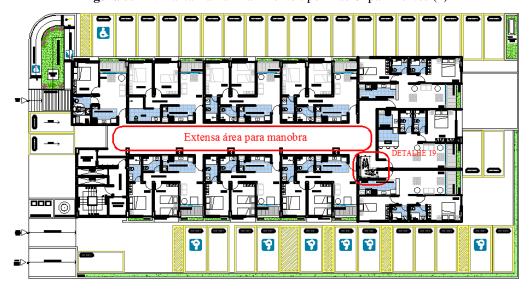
Planta Baixa - Pavimento tipo 1º ao 6º pavimentos (2)
